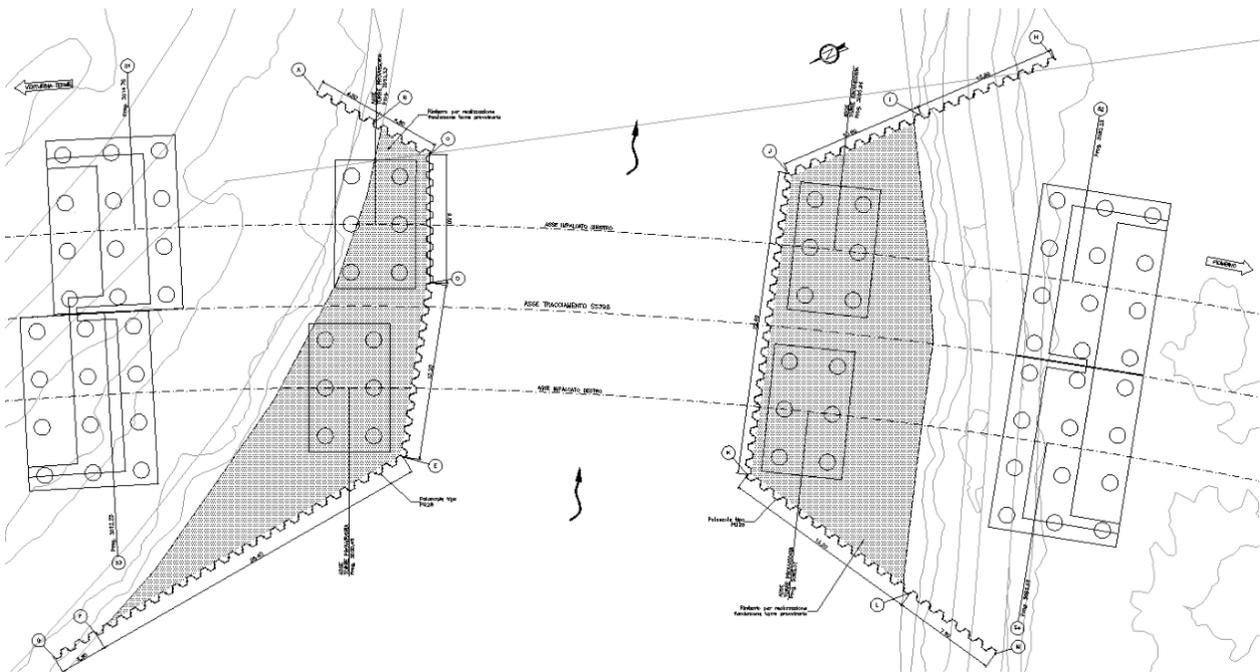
Vista planimetrica delle opere provvisorie previste per il Viadotto V02.
